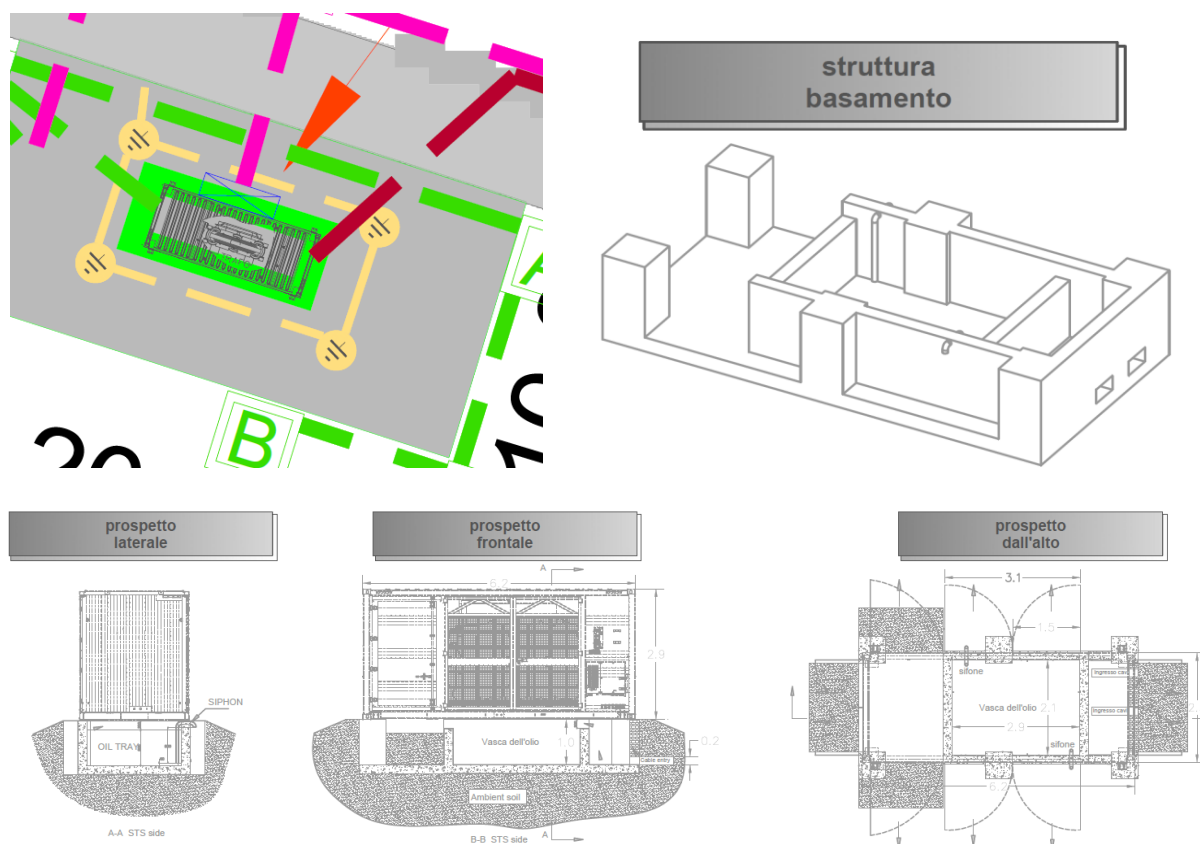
Planimetria, assonometria e sezioni della fondazione dei trasformatori tipo Juppiter.
